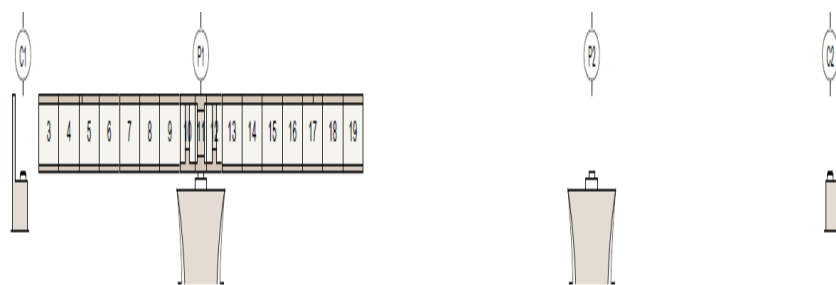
Construction du tablier par encorbellement successifs de la pile 1
